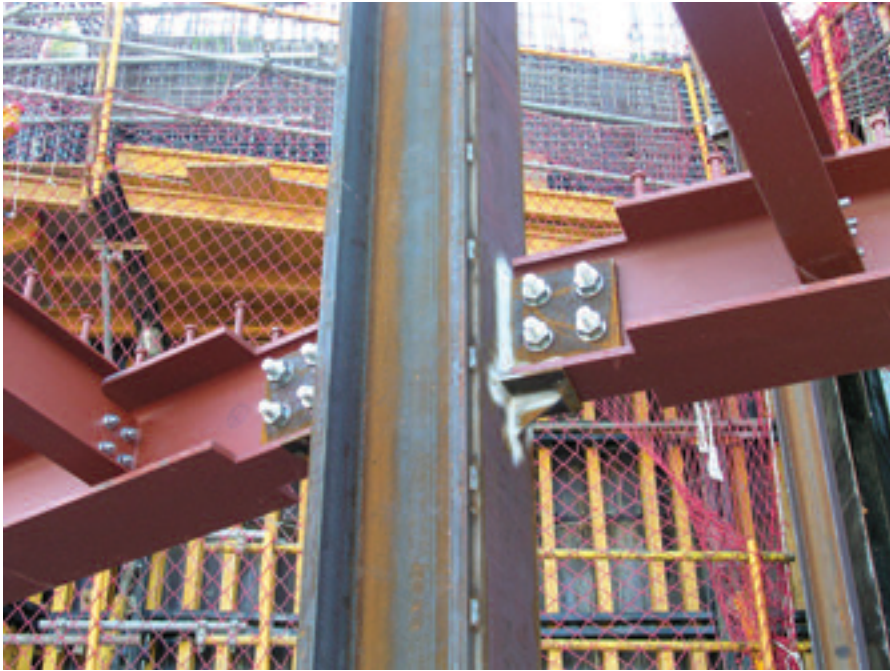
Unión atornillada de vigas principales con los soportes metálicos y embrochamiento de viguetas en vigas principales.
